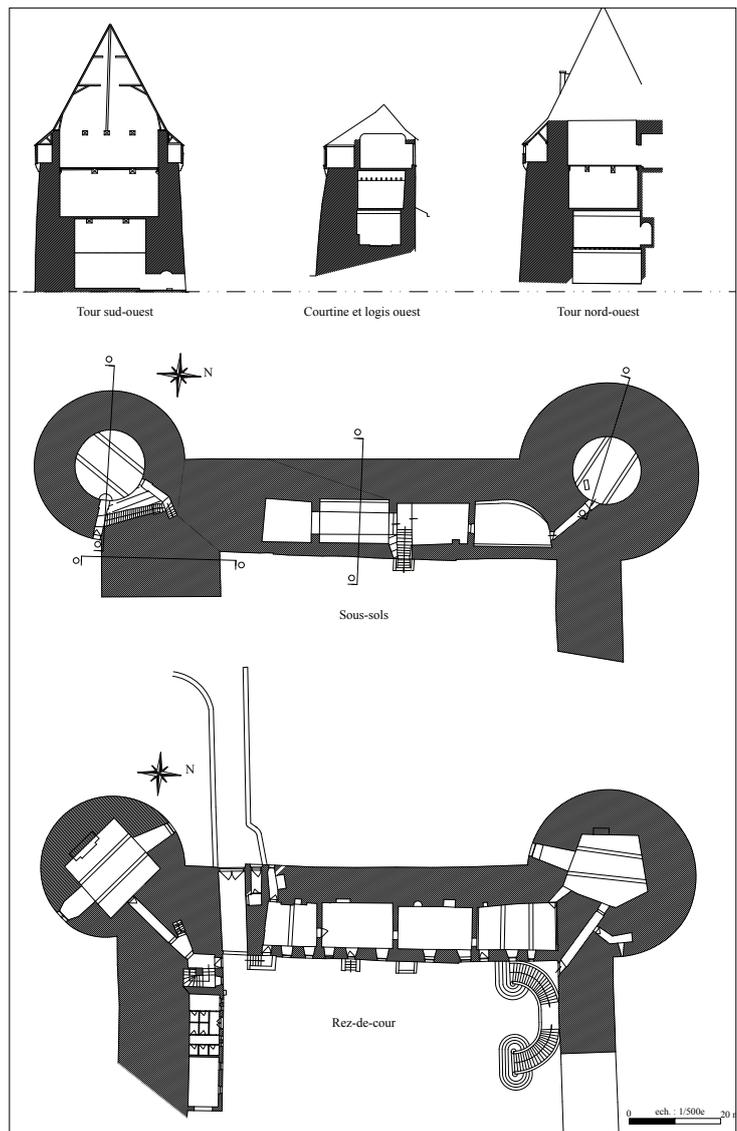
Pontivy, plans généraux par niveau et coupe de la courtine et des tours ouest (DAO Jocelyn Martineau, 2009, d'après plan topographique levé par la ville de Pontivy, 2002)
